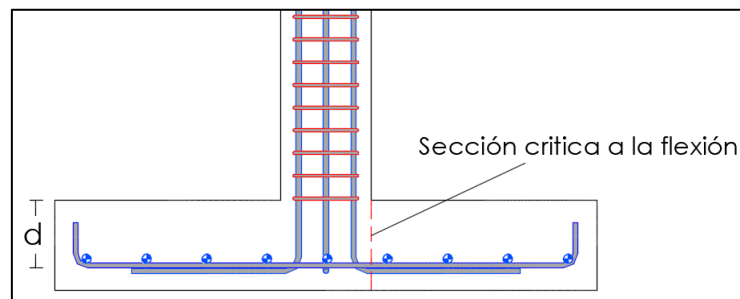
Sección crítica a la flexión en cimentaciones de columnas y muros de hormigón fundidos monolíticamente con la zapata.
